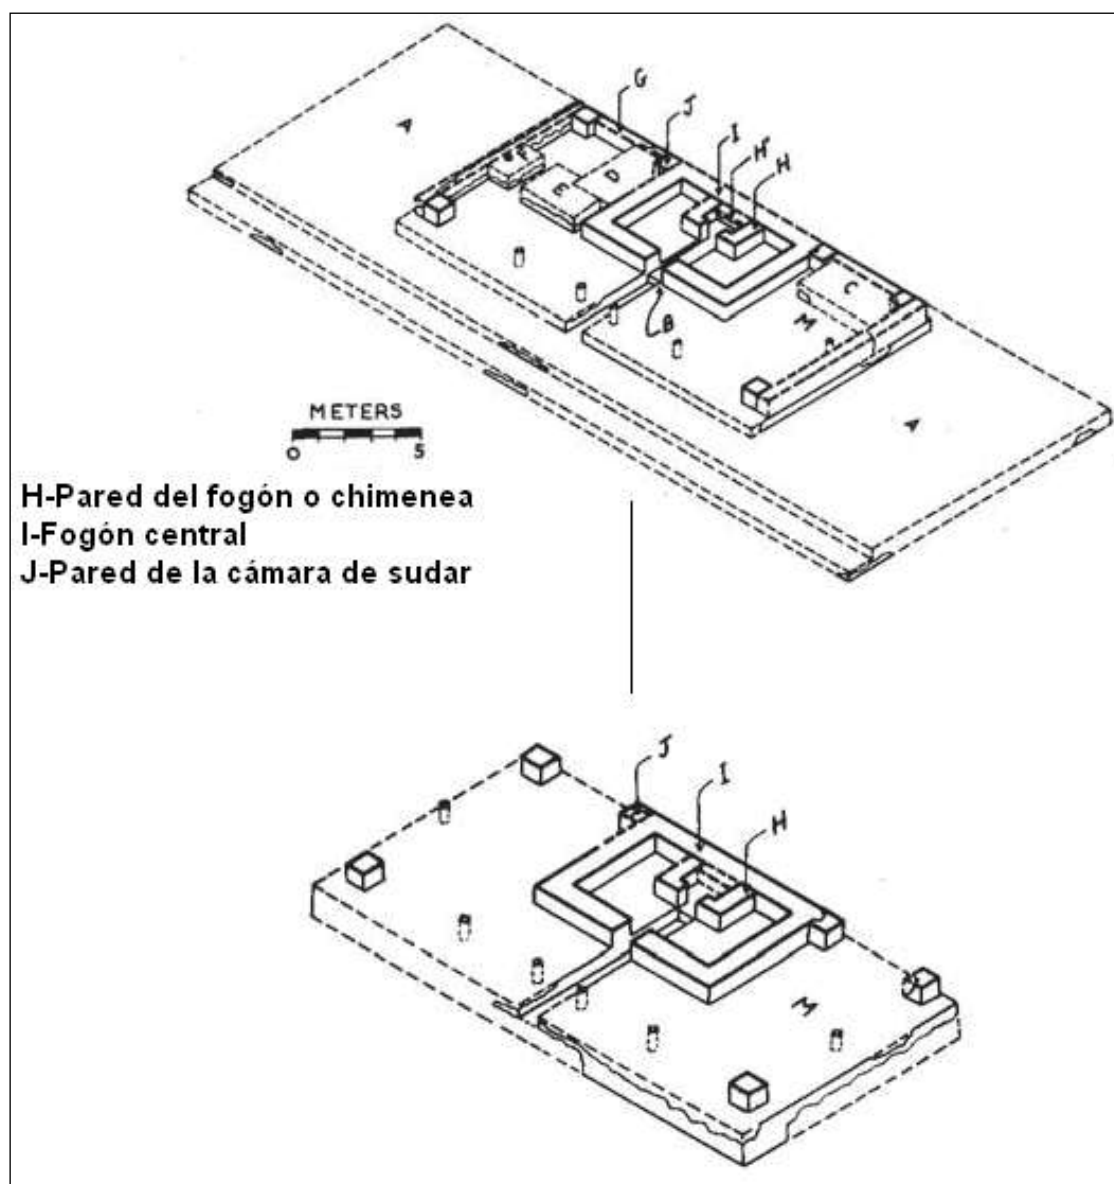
Perspectiva y planta de la Estructura N-1 en Piedras Negras, Chiapas; mostrando sus dos momentos constructivos (retomado de Satterthwaite 1950: figs. 9.8 y 9.9).
